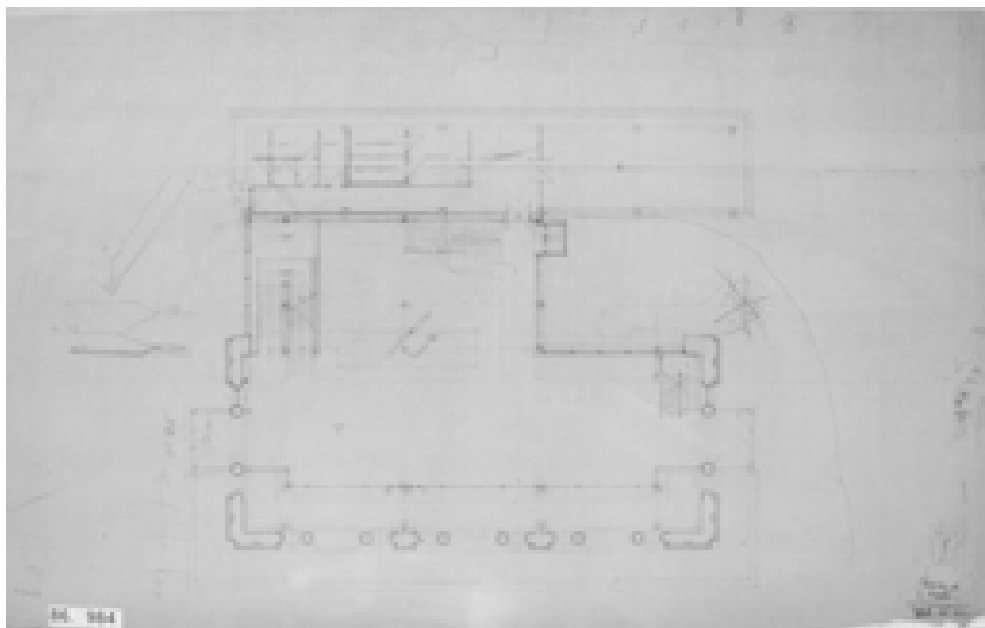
Secondo studio della disposizione planimetrica interna (AABS-984)
